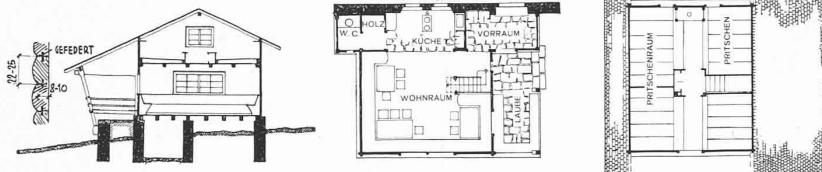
bis 16. Schnitt und Grundrisse Elmerberg. — 1 : 300.
